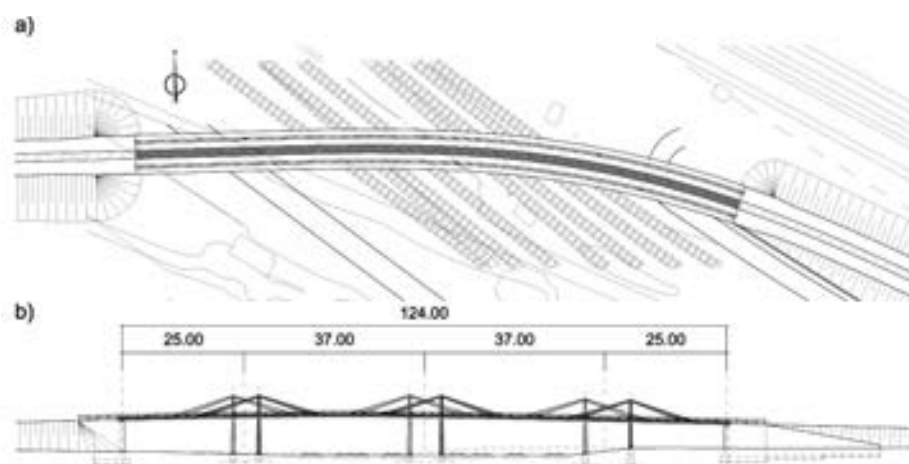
Puente extradosado; a) Vista en planta; b) Alzado longitudinal
